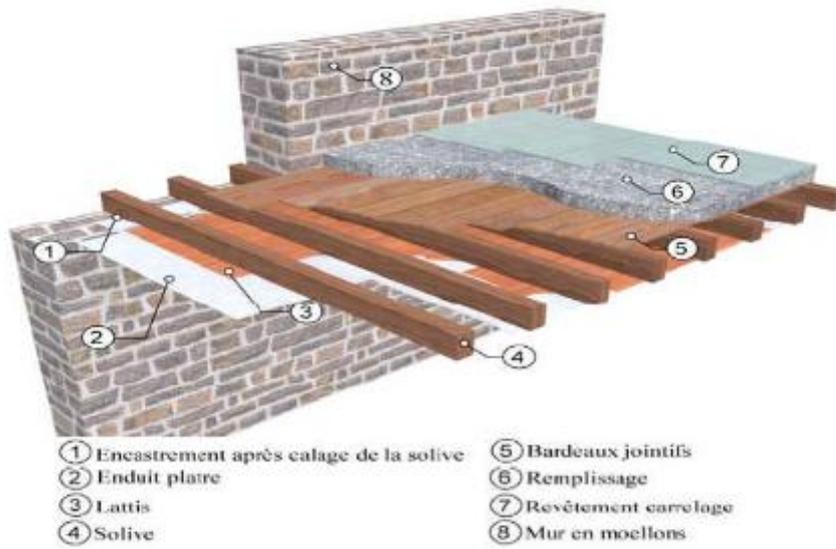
Détail d'une structure traditionnelle : mur porteur en moellons avec plancher en bois, source, Auteur
